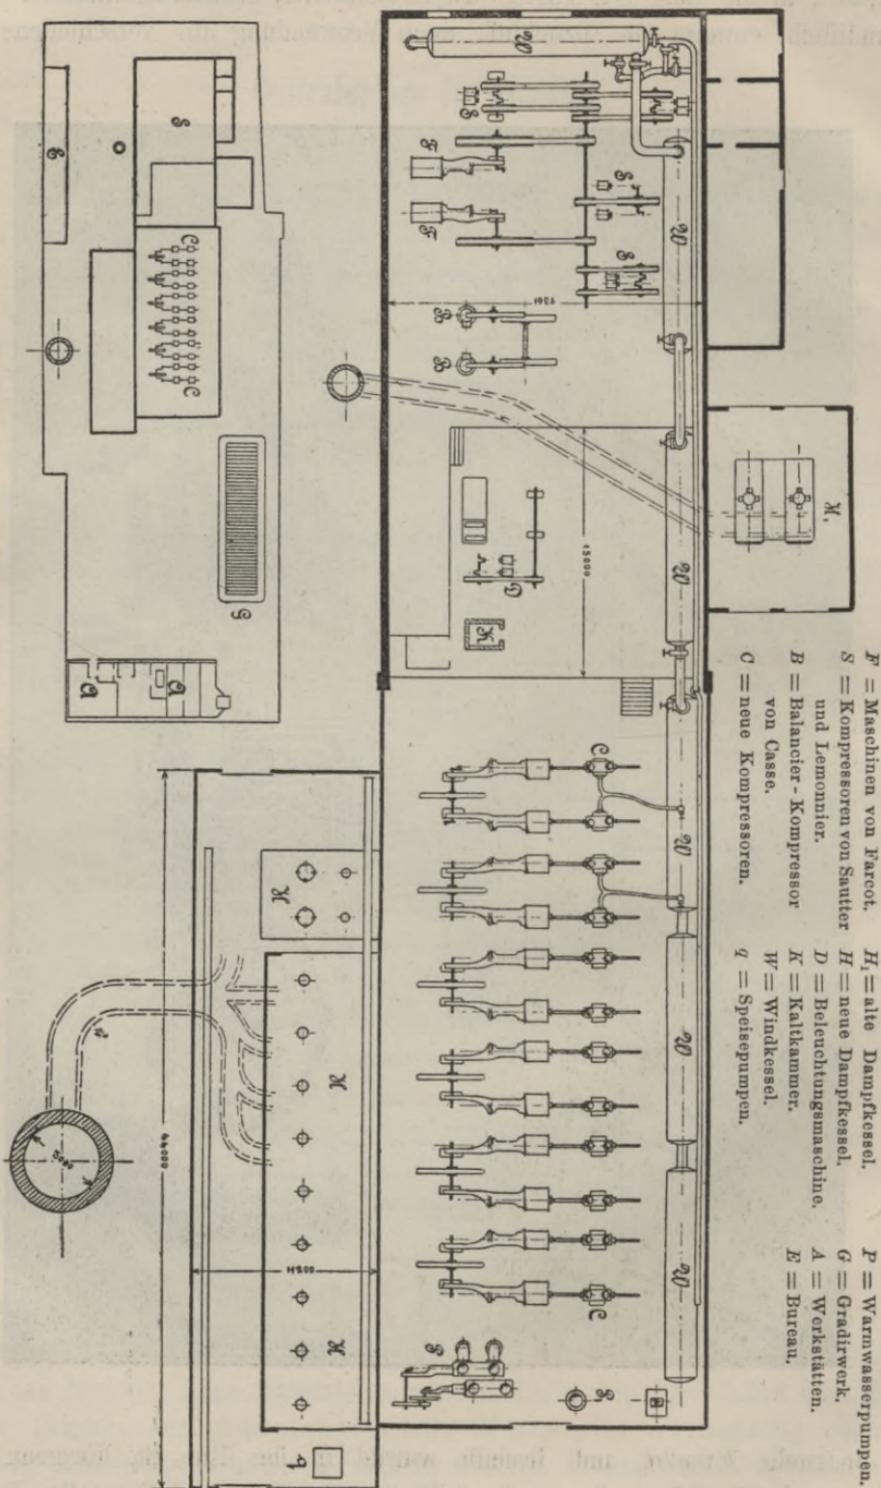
Grundriss der Central-Anlage. Maasstab 1 : 500 und 1 : 2000.
